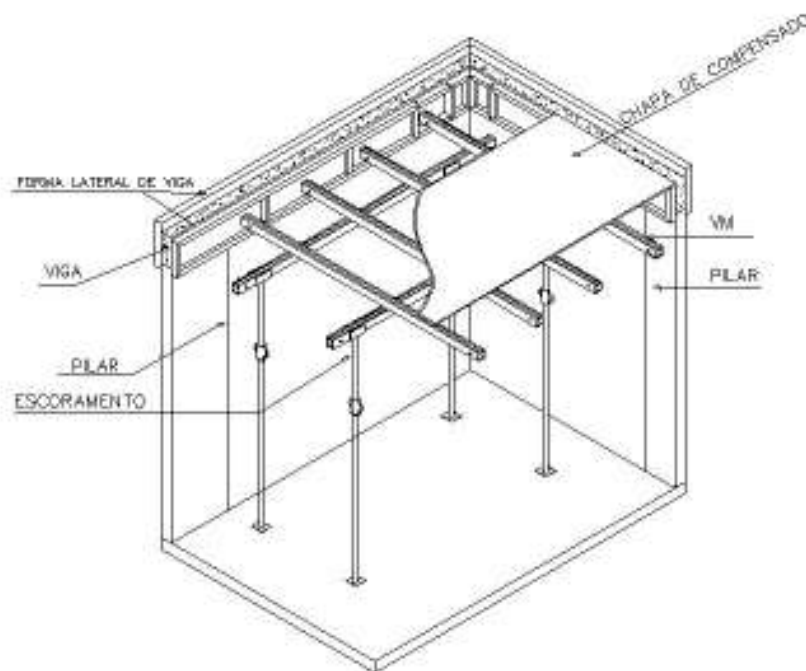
representação esquemática da execução da estrutura de concreto armado convencional (trabalho não publicado)¹
